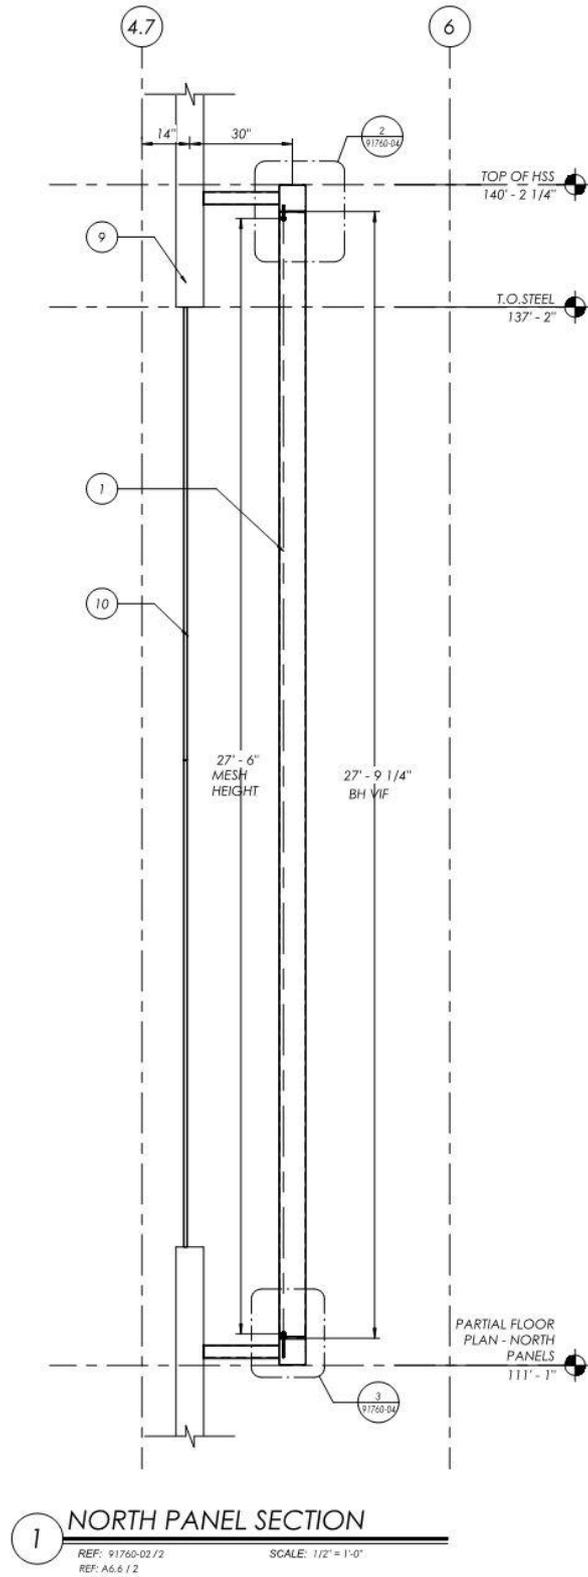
Sección de los paneles orientados hacia el norte. En el mismo se puede observar la estructura de sujeción y los perfiles ángulos colocados delante y detrás de la malla metálica
